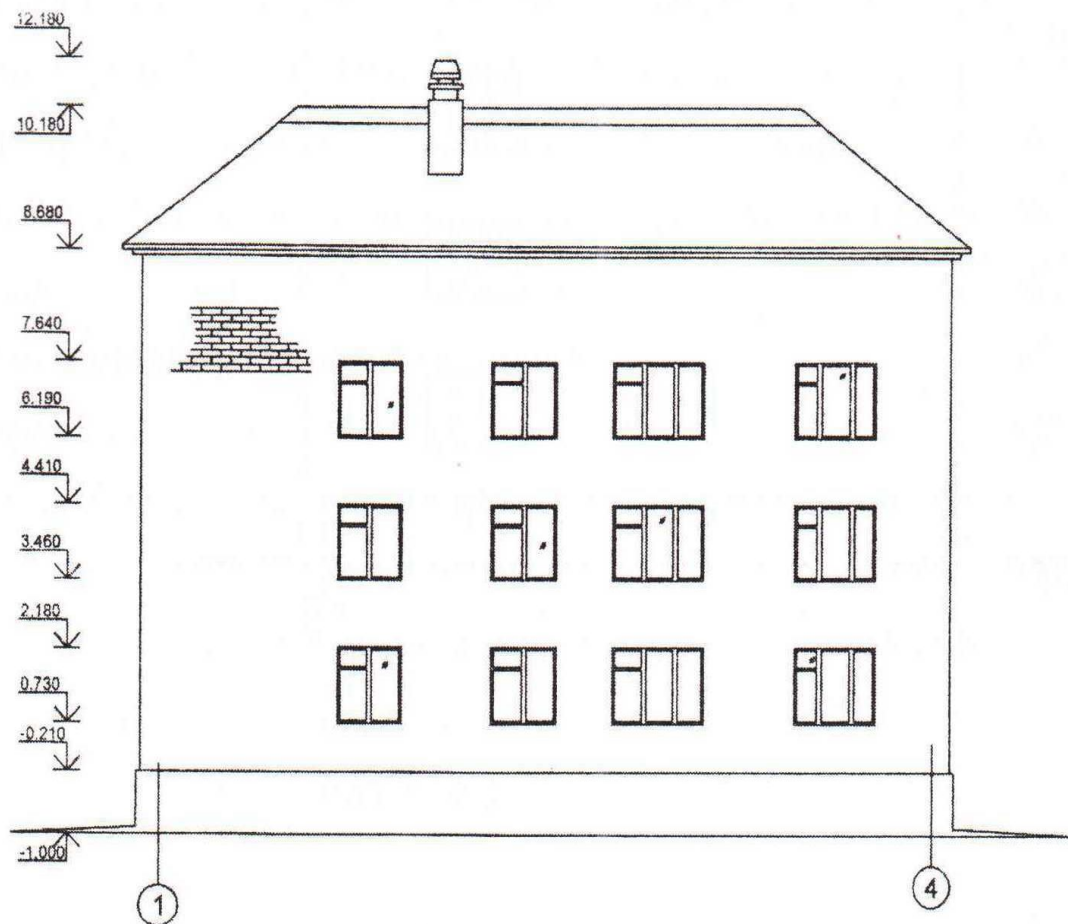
Фасад будівлі (головний) М 1:100
